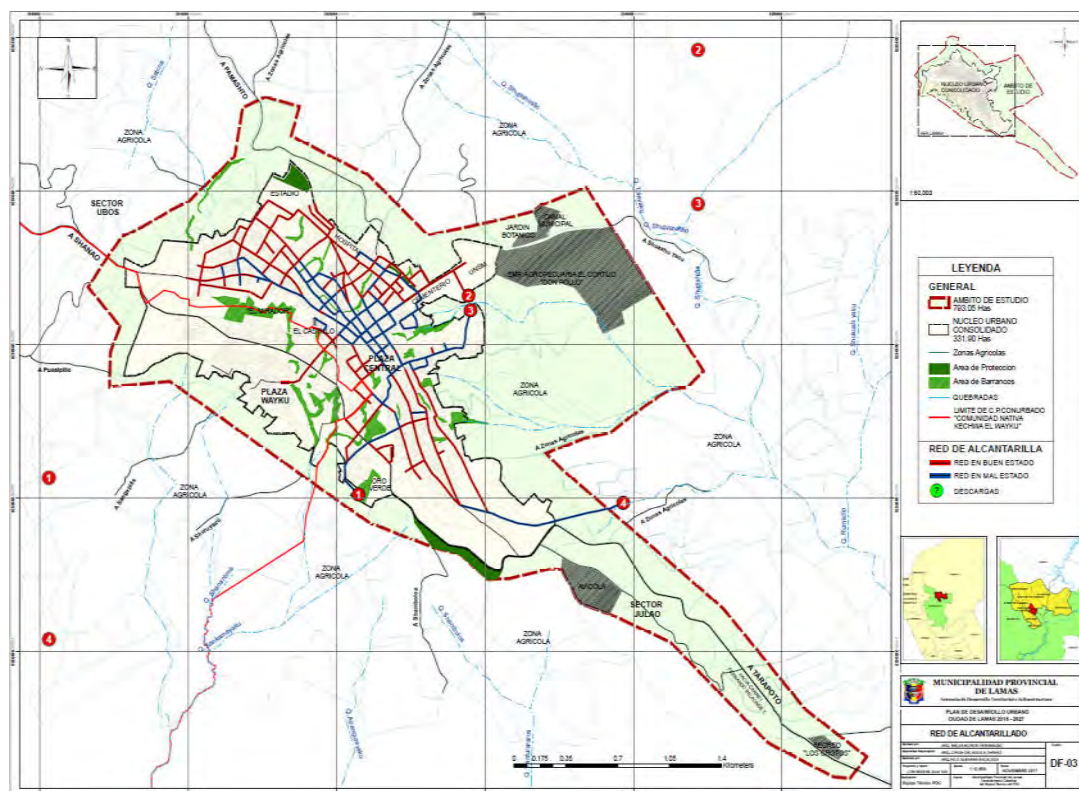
Plano de red de alcantarillado de la ciudad de Lamas.
